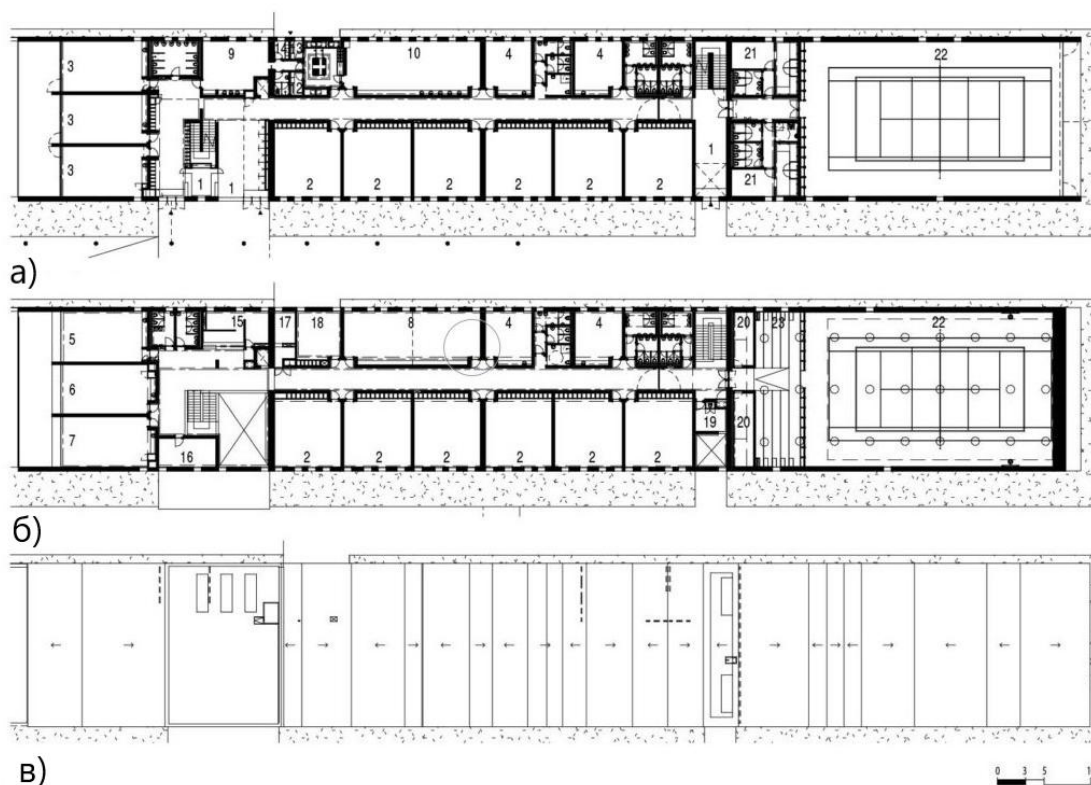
План помещения начальной школы в Моурис, Паредес, Северная Португалия. а) первый этаж; б) второй этаж; в) план кровли.
